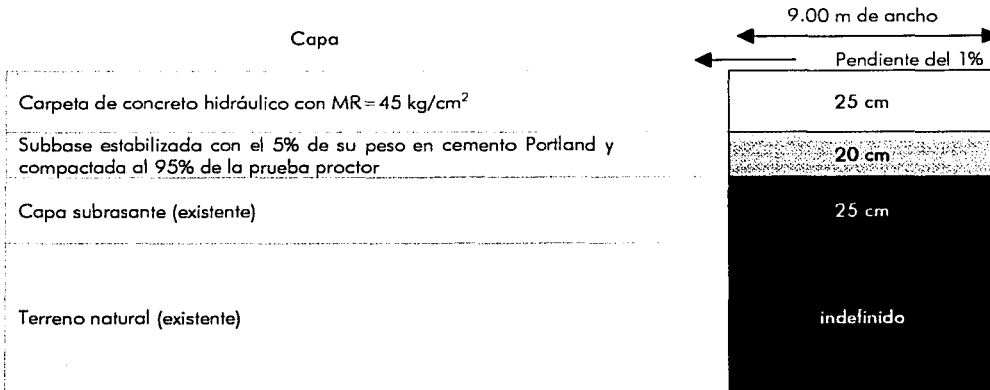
Sección transversal para el pavimento de los dos cuerpos laterales.
